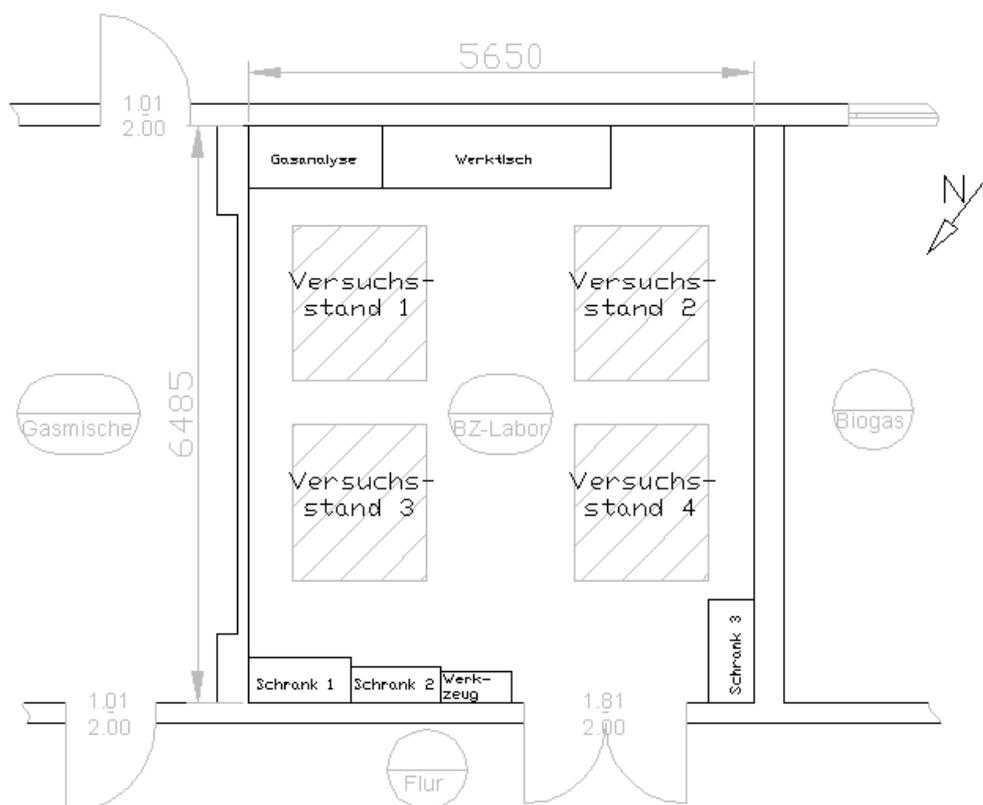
Grundriss des Brennstoffzellenlaboratoriums, ohne Maßstab
